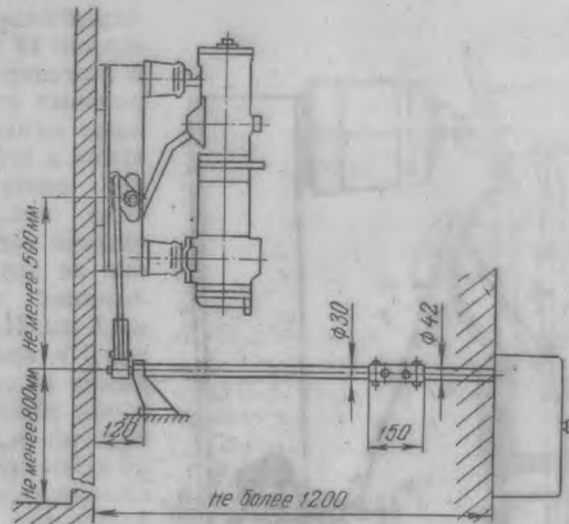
Установка выключателя ВМП-10 и привода ПЭ-11
